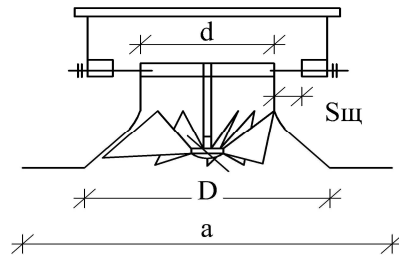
Конструктивні розміри повітророзподільника: 1) припливний патрубок; 2) дифузор; 3) кільцева регульована щілина; 4) пластини; 5) ручка керування; 6) відбійний козирець; 7) гвинт регулювання щілини; 8) стержень
